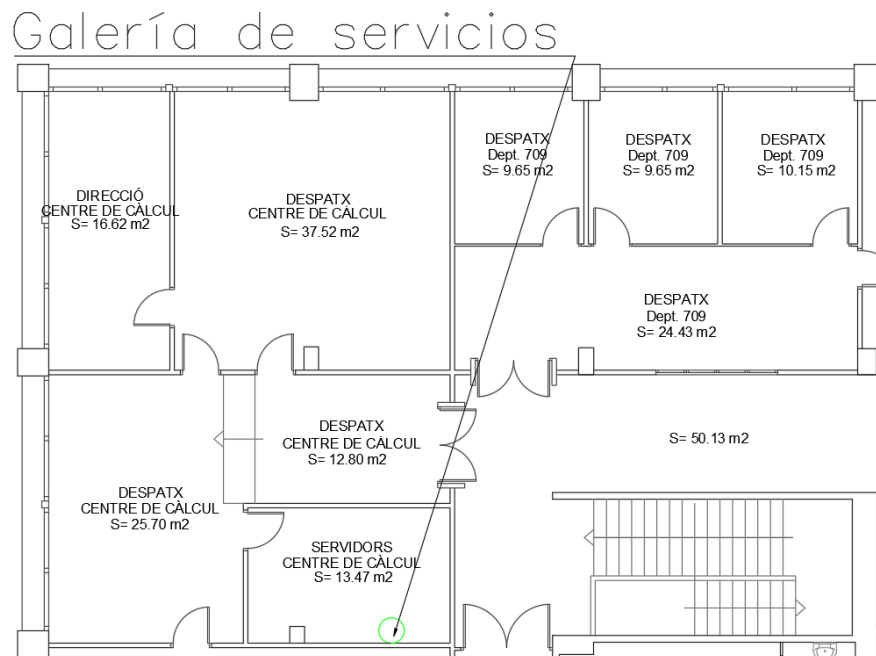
Plano de ubicación de la galería de servicios en la planta 1.
